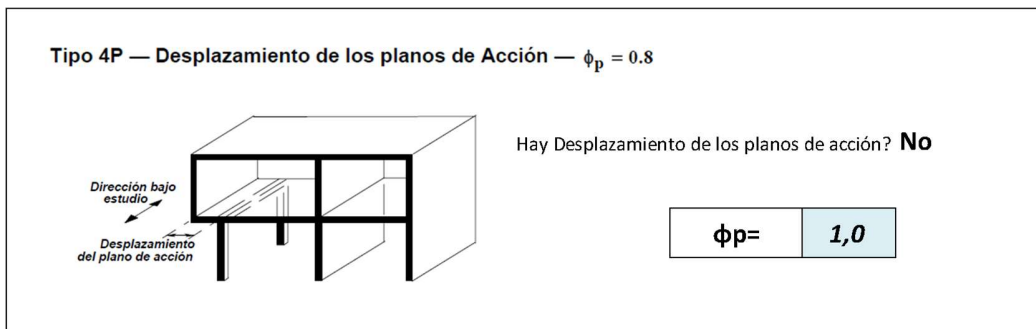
CONDICIONES 4P DESPLAZAMIENTOS DE LOS PLANOS DE ACCION
